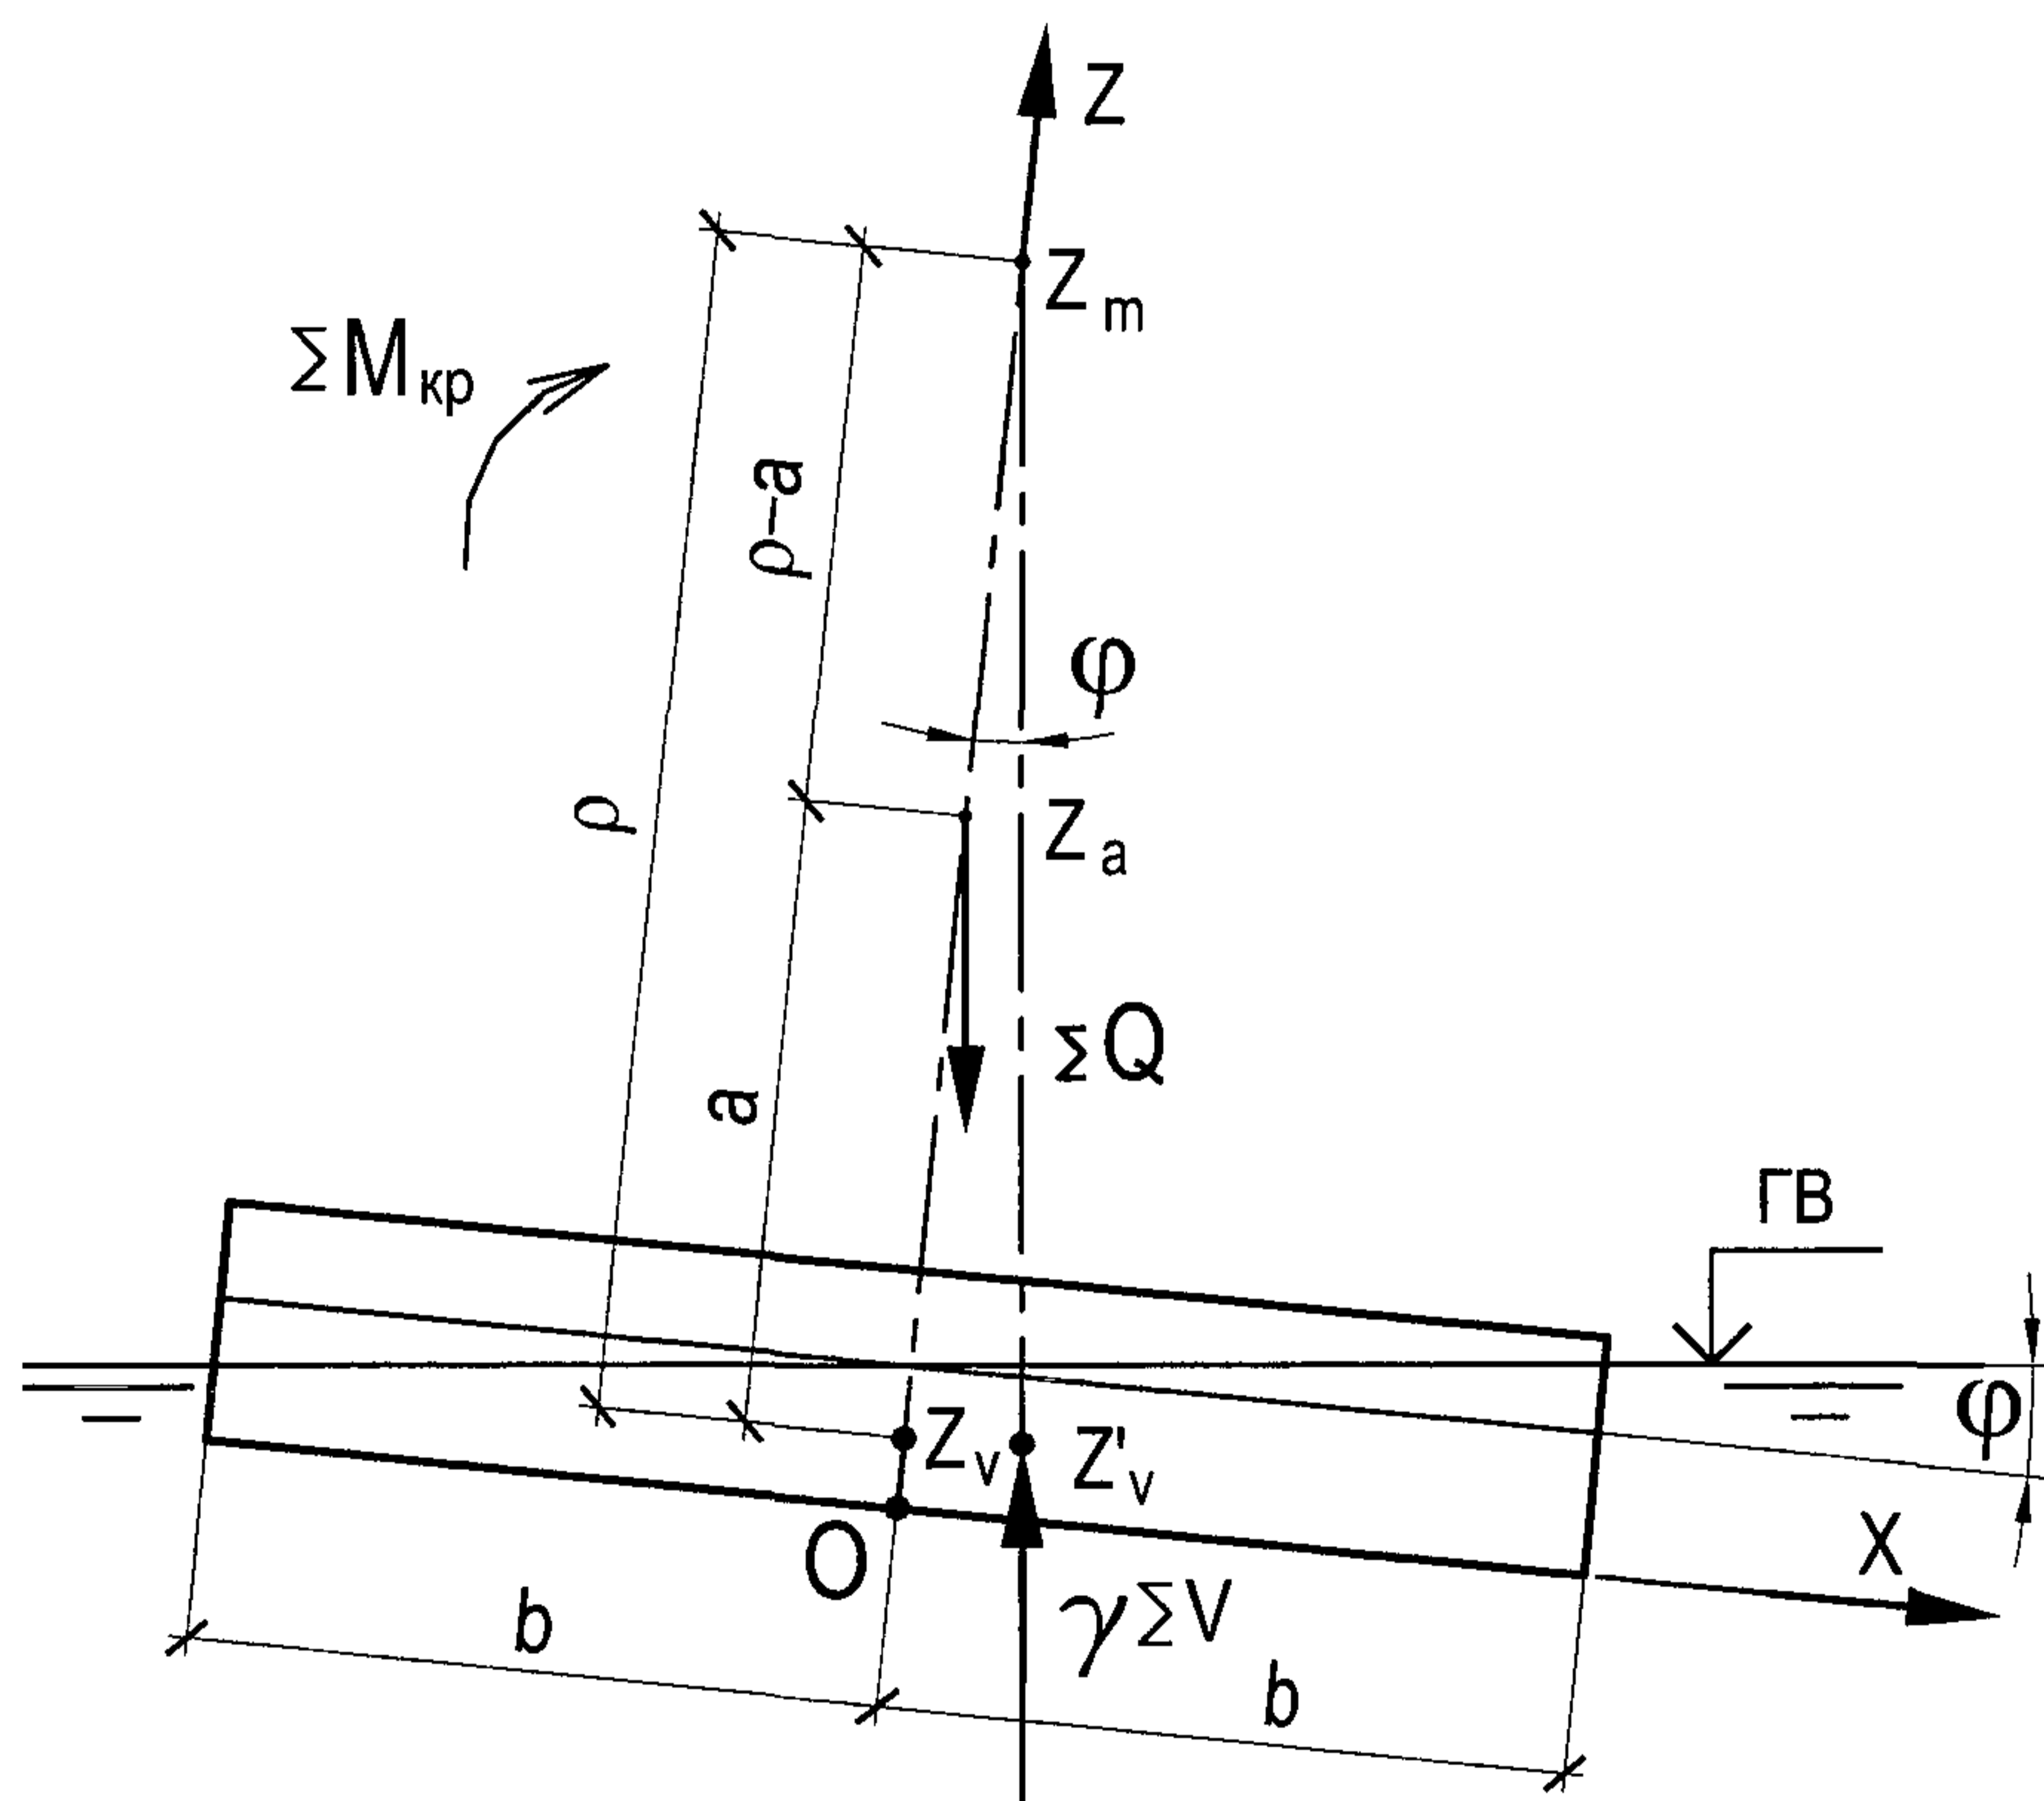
Схема определения устойчивости плавучей опоры.
